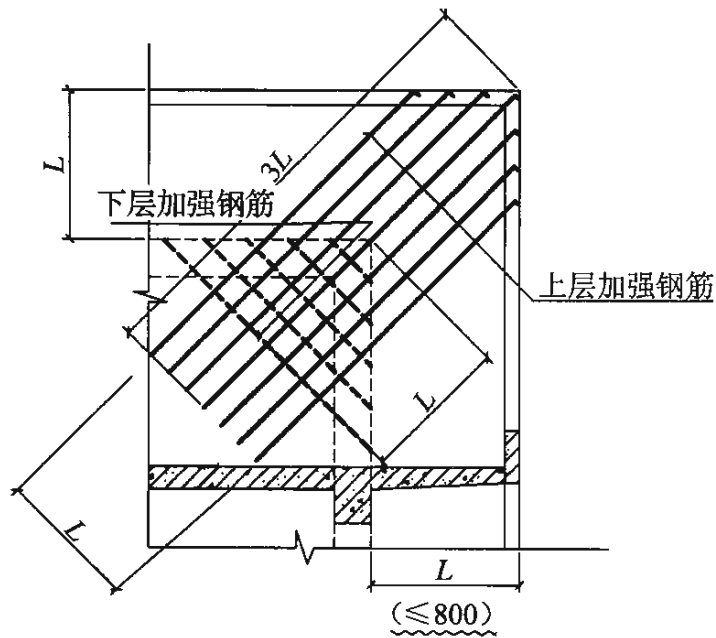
挑檐转角位于阳角时的加强配筋 图 5.3.10-2 挑檐转角位于阳角时的加强配筋
